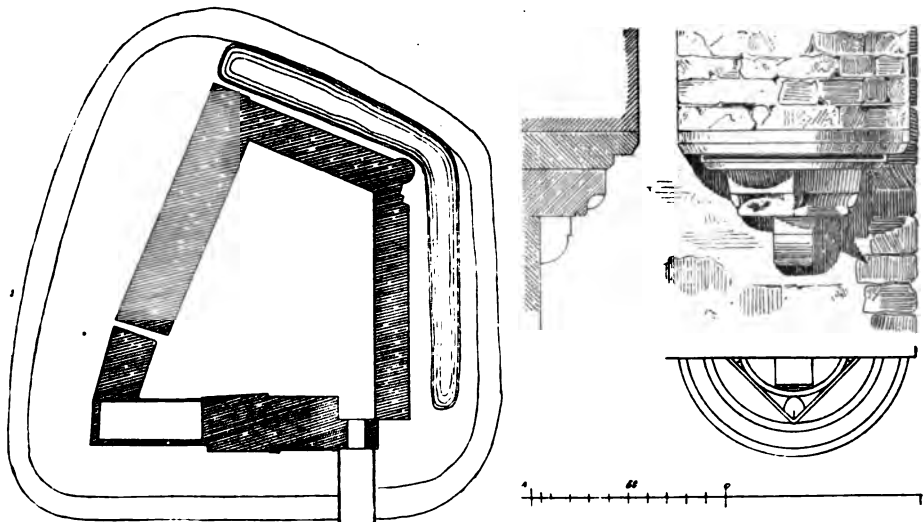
Burg Irnich. Lageplan und Details des Thorbaues.
